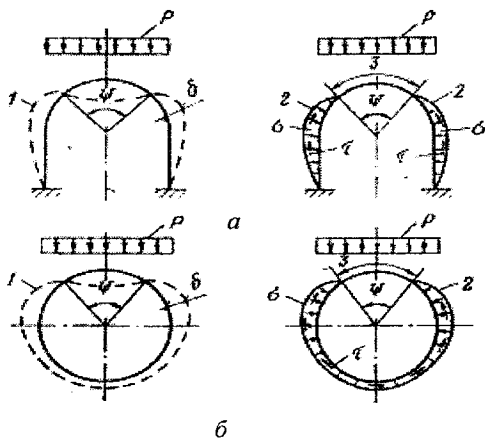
Схеми дії пружного опору ґрунту на кріплення склепінного (а) і кругового (б) обрису:
